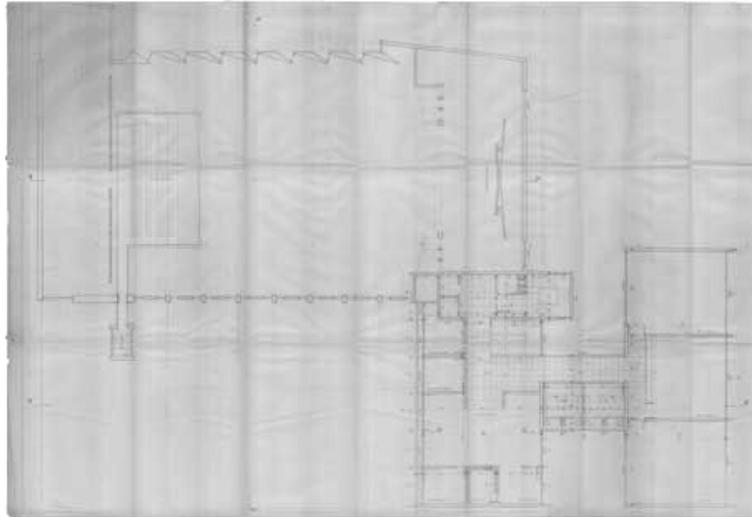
Planta 1º pavimento Nave e Edifício. Fonte: Acervo FAM.
